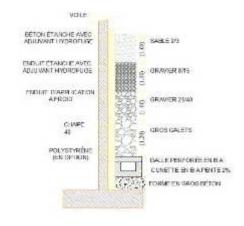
Voile et drainage Source :http://www.mesmateriaux.com/
